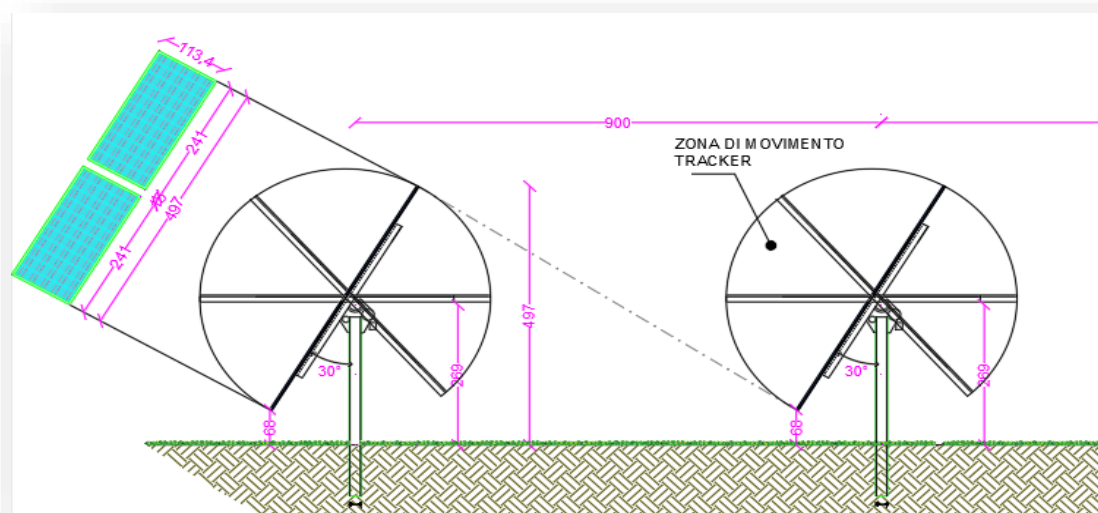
Sezione tipo impianto con installazione su sistema ad inseguimento solare tipo tracker
